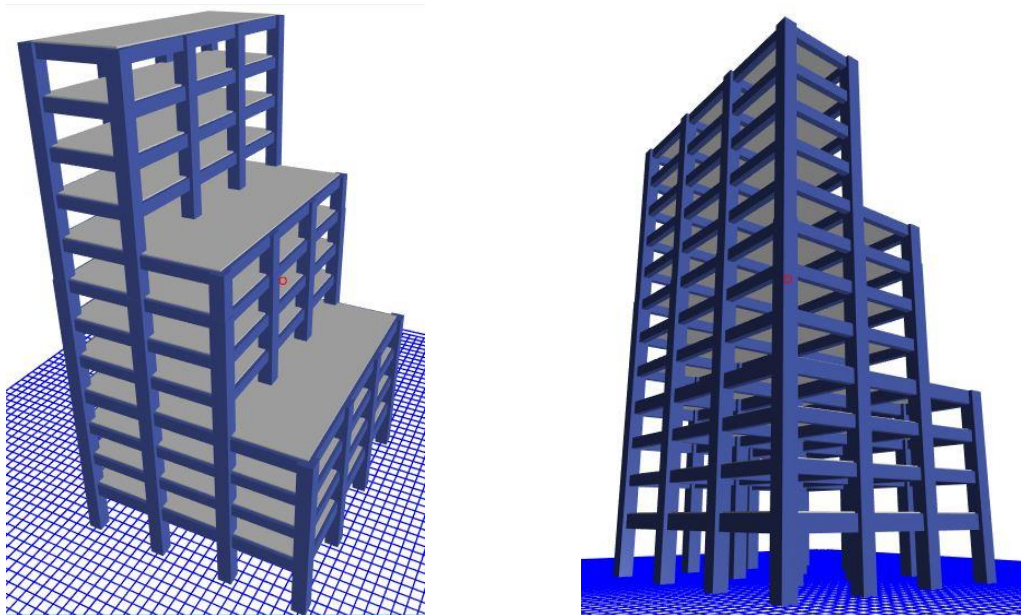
VISTA GENERAL DE LA ESTRUCTURA
